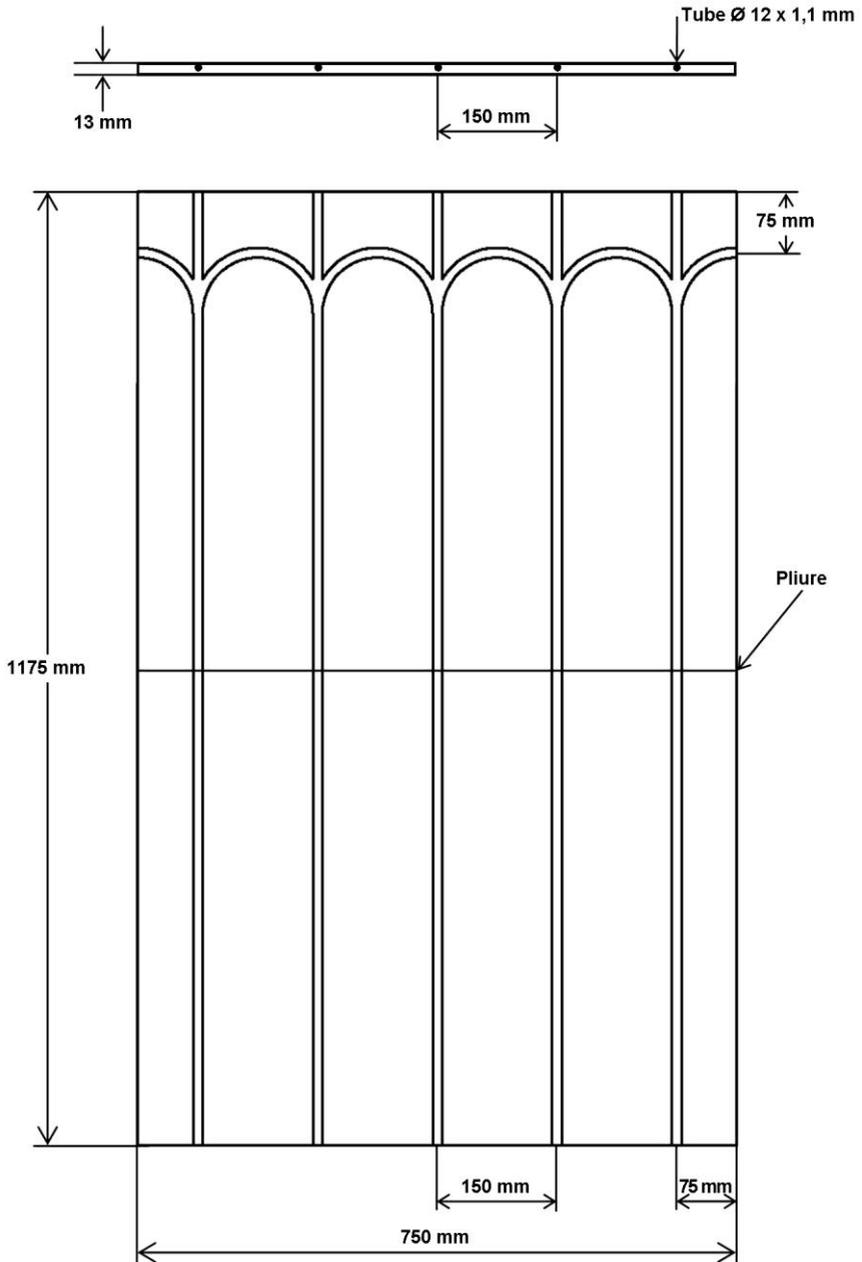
Plan plaque RENOPLUS épaisseur 13 mm
